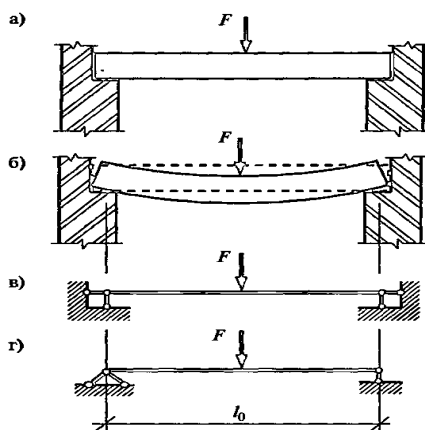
Вариант опирания балки на кирпичные стены:
